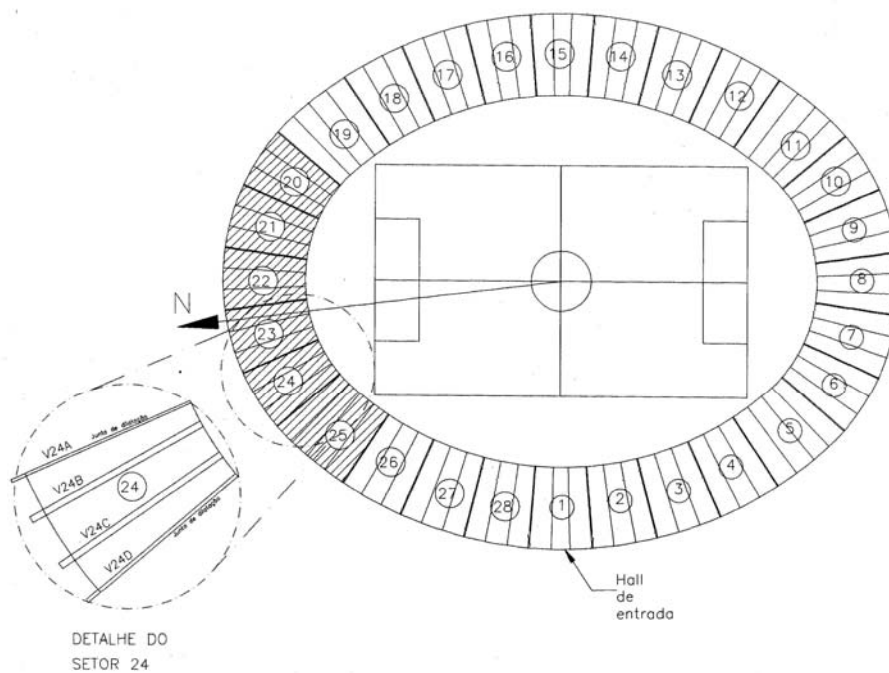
Localização das vigas de cobertura em que foram feitos os levantamentos das fissuras – setores 20 ao 25
